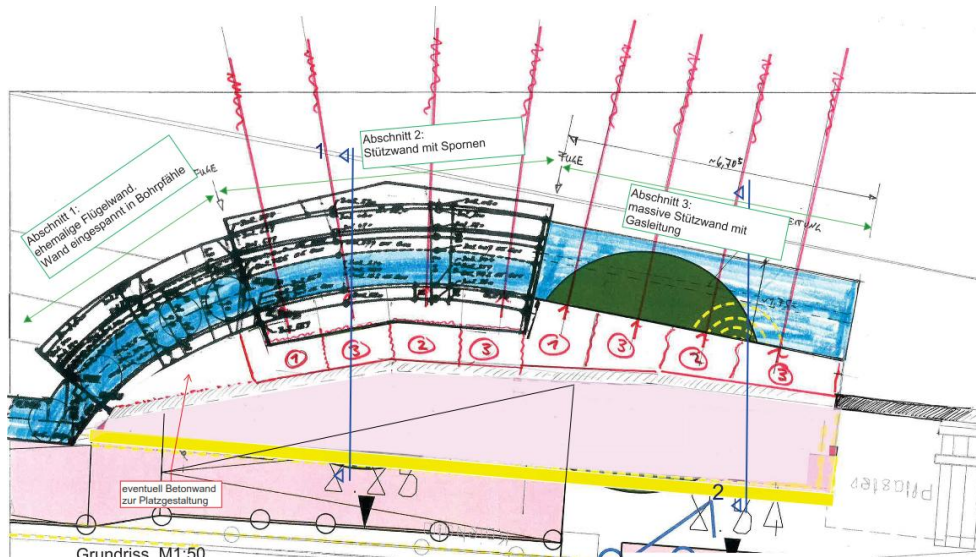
Skizze Grundriss mit Sicherungsmittel, IGR [9], o.M.
